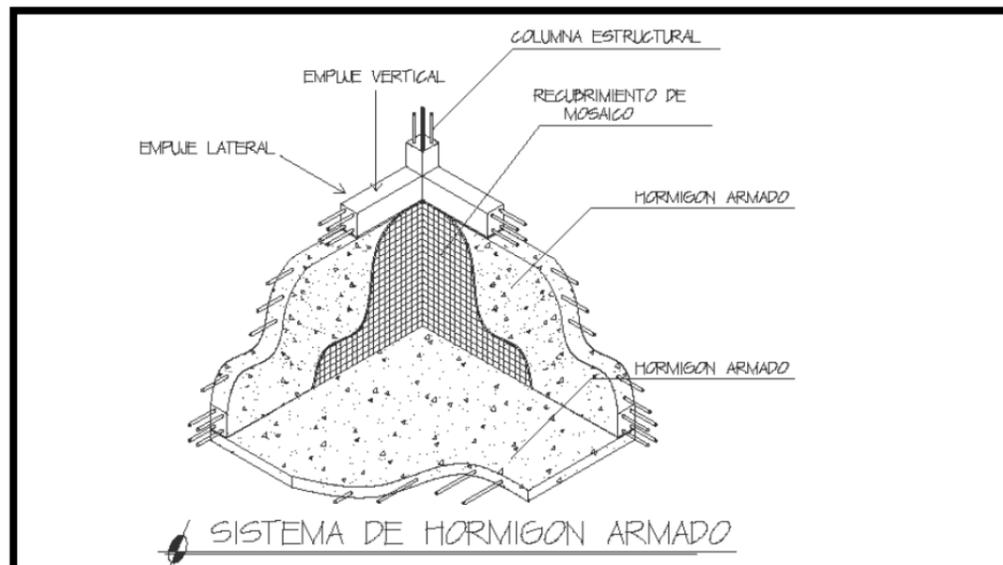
Detalle de armado de zapata fuente: Tutor
